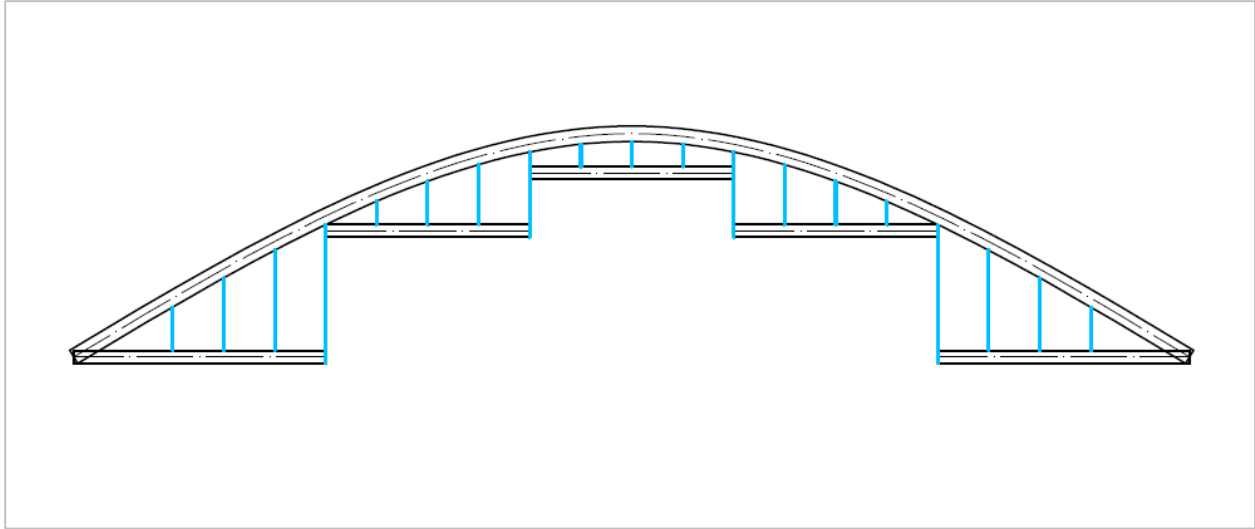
4. Puente móvil de tablero inferior y elevación modular.
